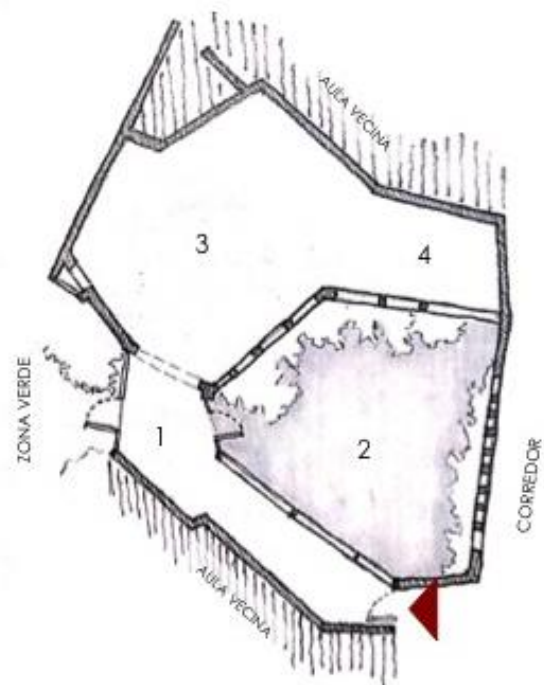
Planta aula tipo 1 Geschwister Scholl Schule.
